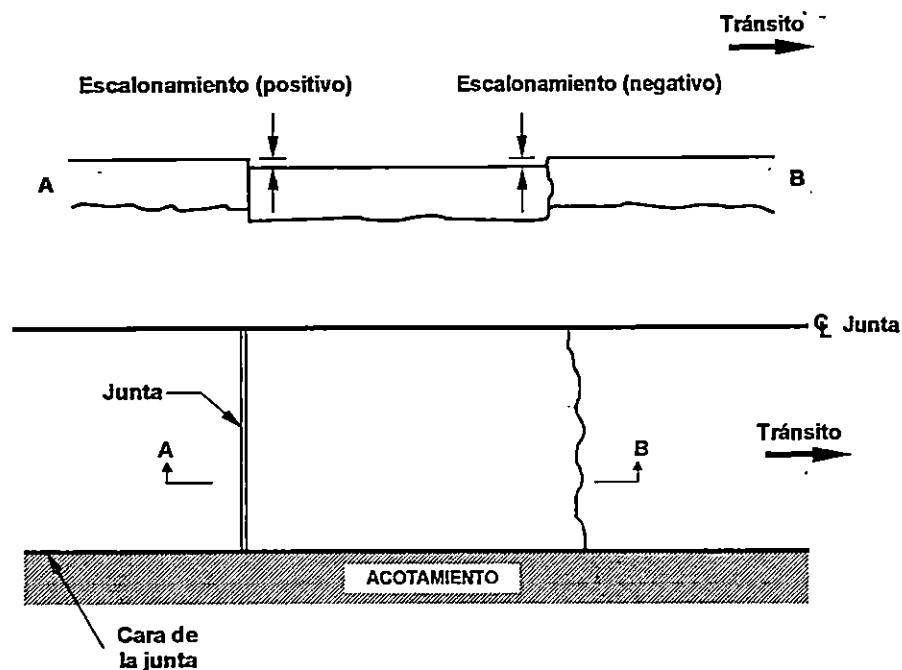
Escalonamiento de juntas transversales y grietas.
